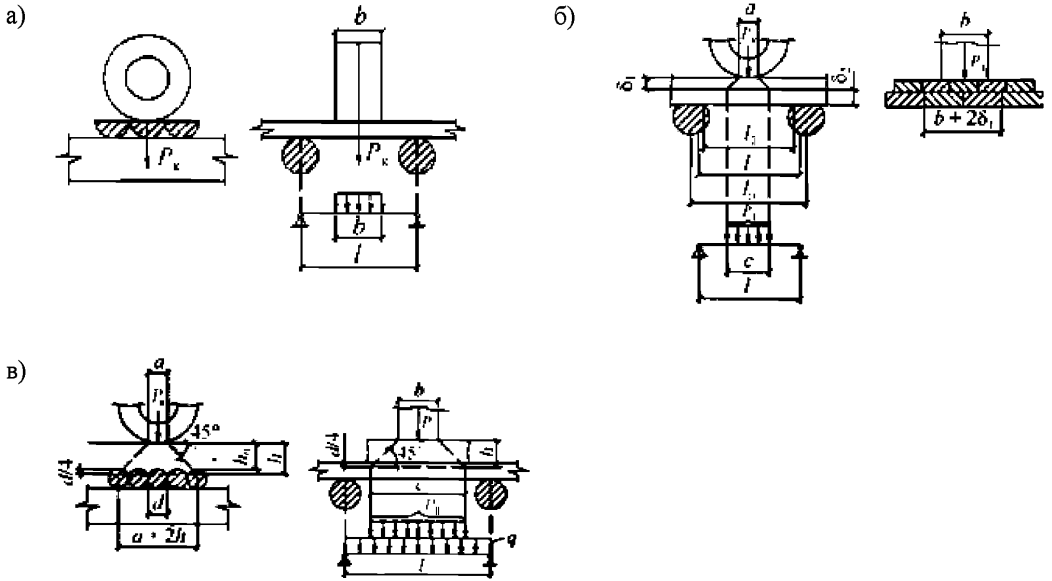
Схемы к учету нагрузок на поперечный настил при отсутствии поперечин:
